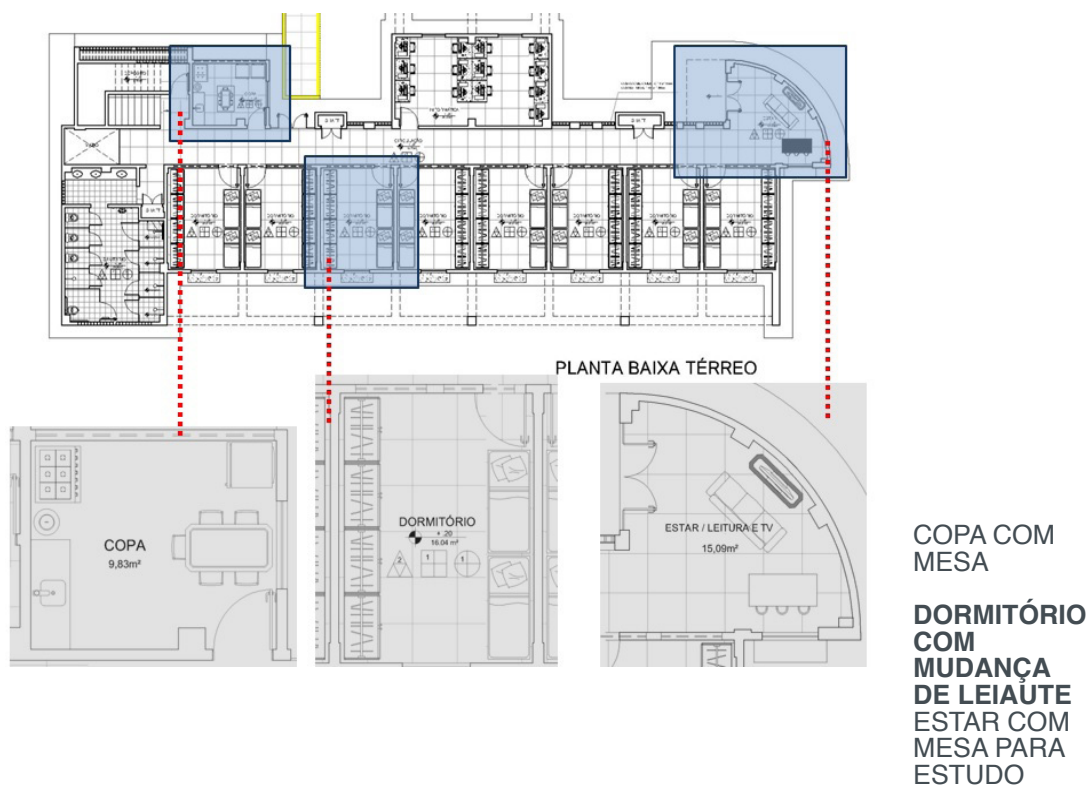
Planta baixa do “as built” na RU-Campus III (2015).
